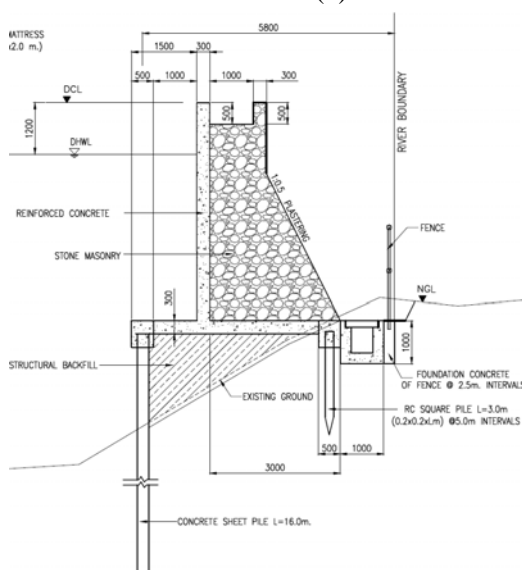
コンクリート擁壁の標準断面図(1/2)
